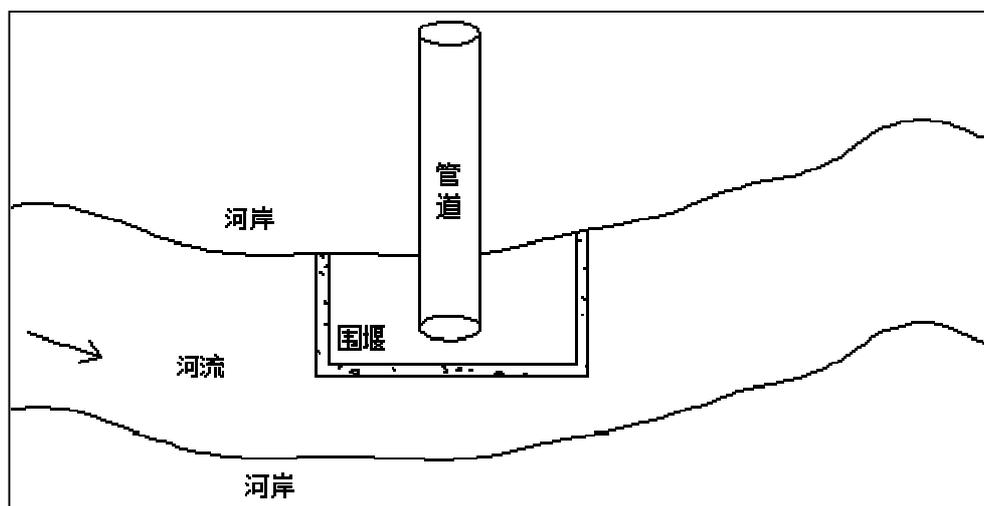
围堰导流开挖管沟法施工断面示意图
